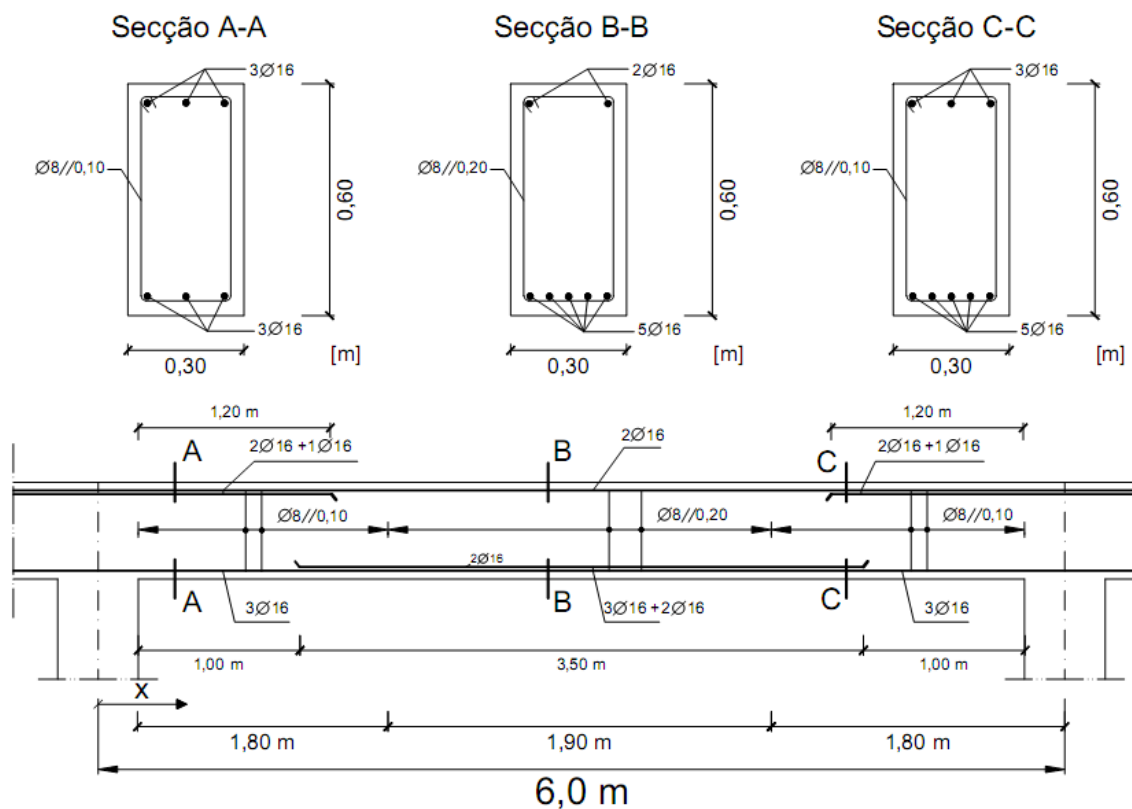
Pormenorização da armaduras (Caso D – secção retangular)
